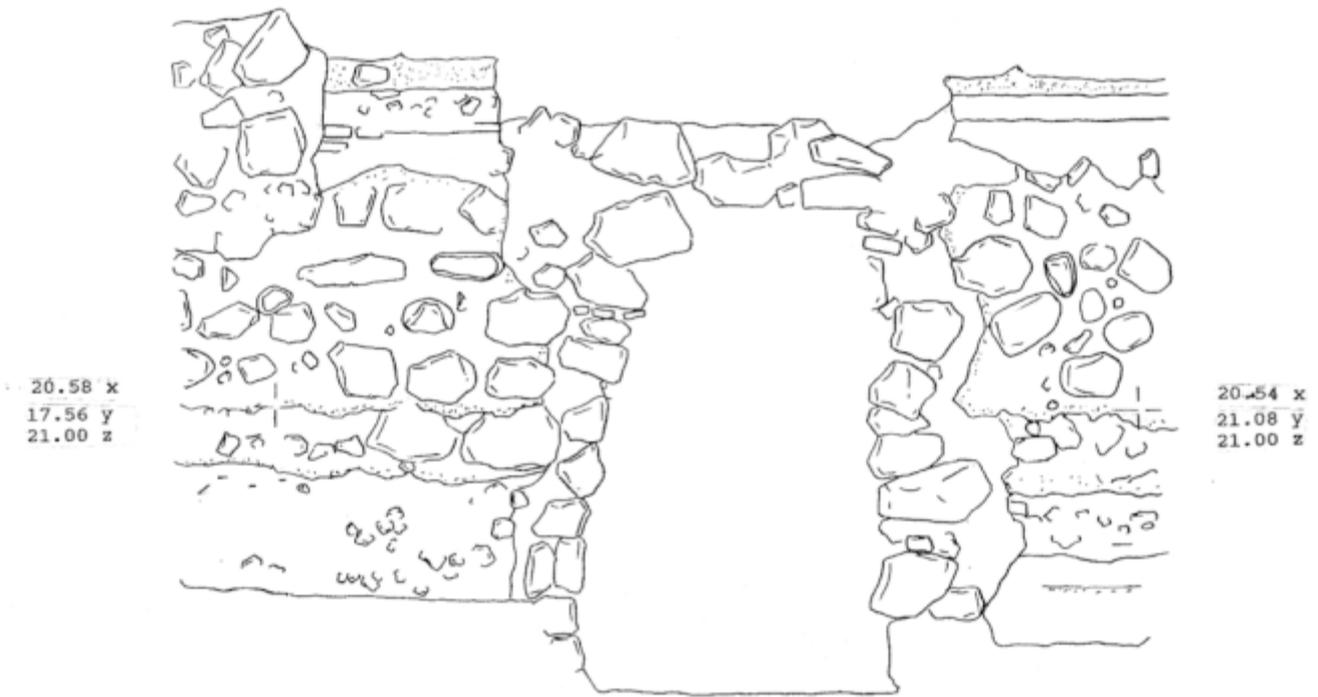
Alzado de la cara interna de la muralla. Área 4. Escala 1:40.
